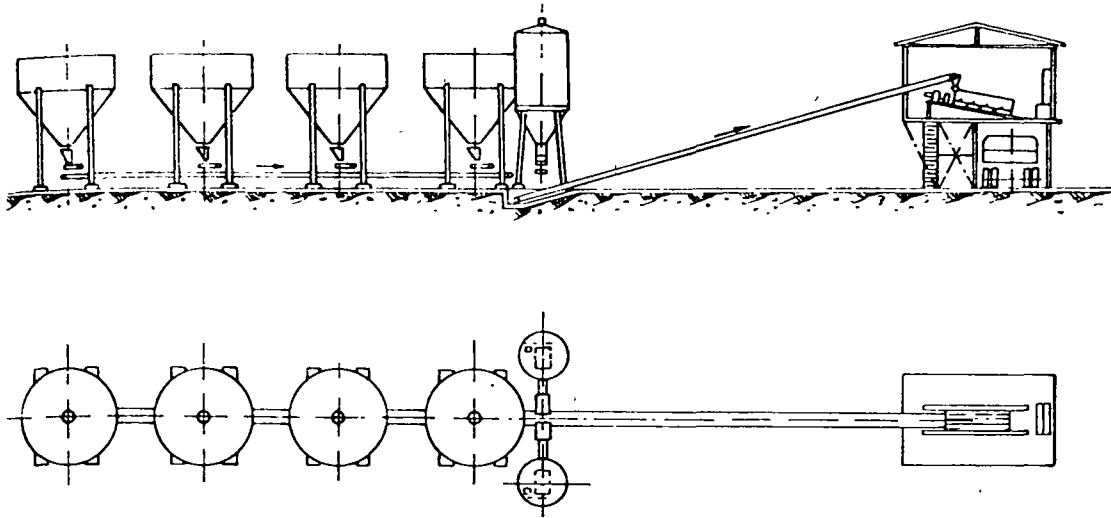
Planta central de concreto Autocrete (Europea).
